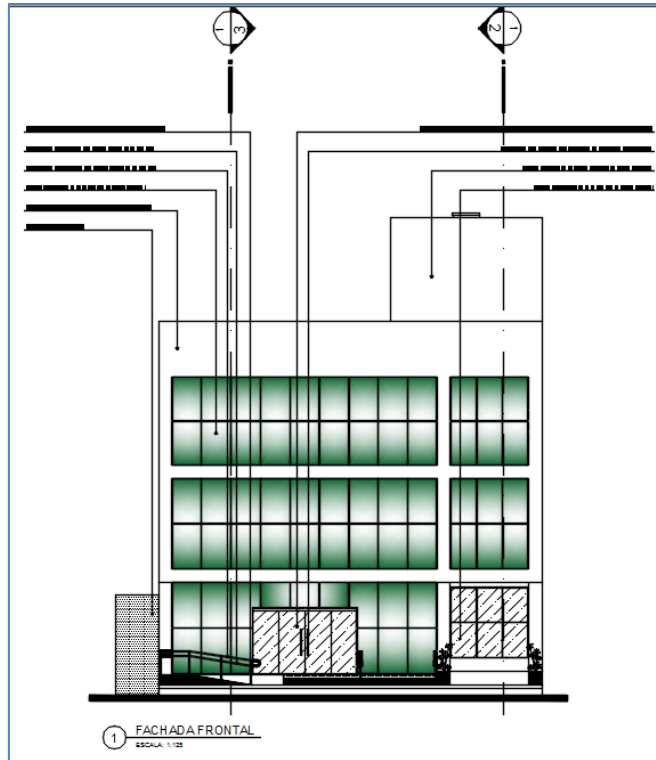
Planta baixa: fachada frontal (autor do projeto arquitetônico)
